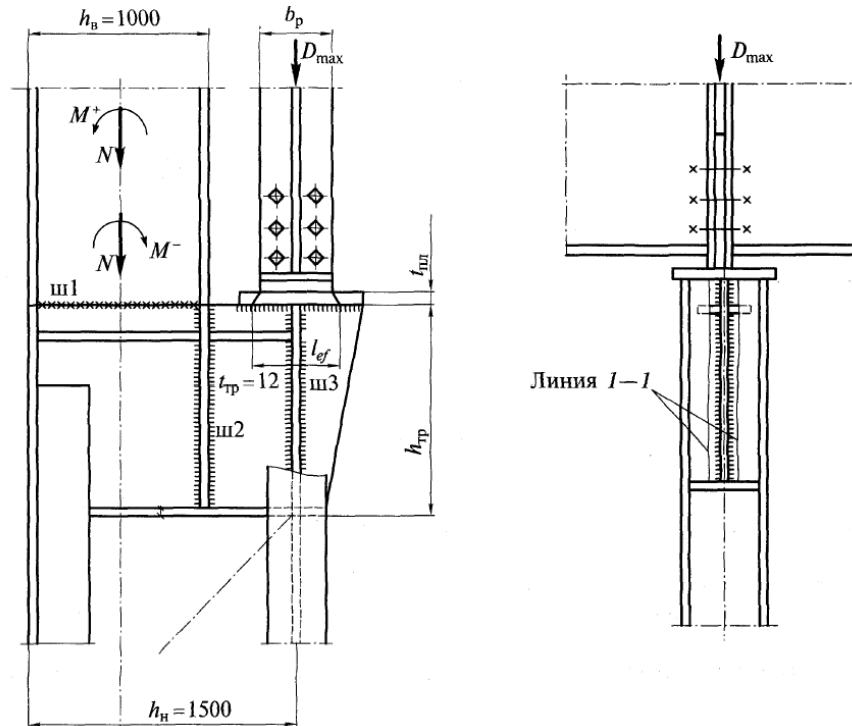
Расчетные схемы узла сопряжения верхней и нижней частей колонны
